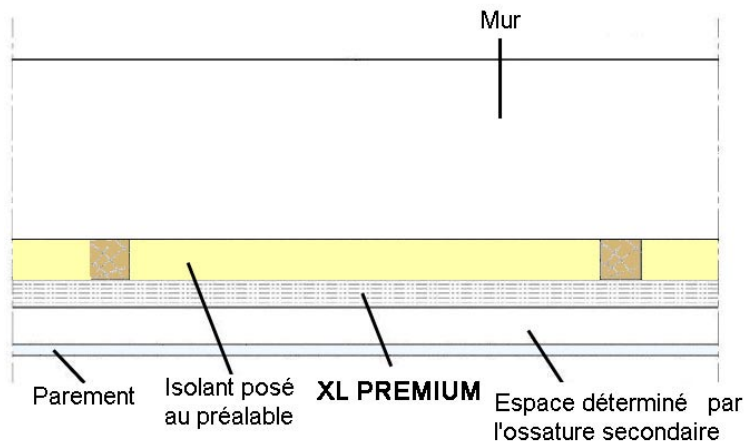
Schéma de pose sur mur en maçonnerie courante ou en béton.
